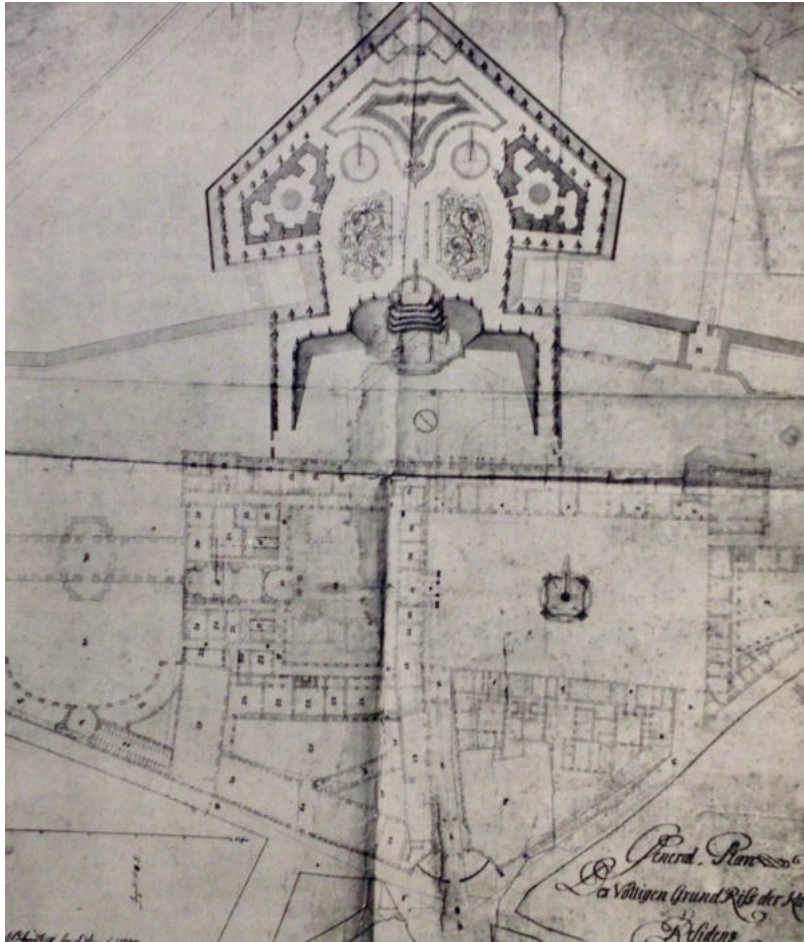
Grundriss für den Umbau der Burganlage mit der Burggarten, J. L. v. Hildebrandt, 1725
